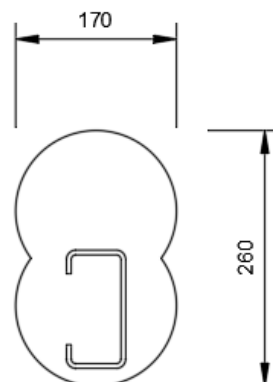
Mindestabmessungen für die Aussparung im Asphalt, z.B. durch überlappende Doppelbohrung 170 mm
